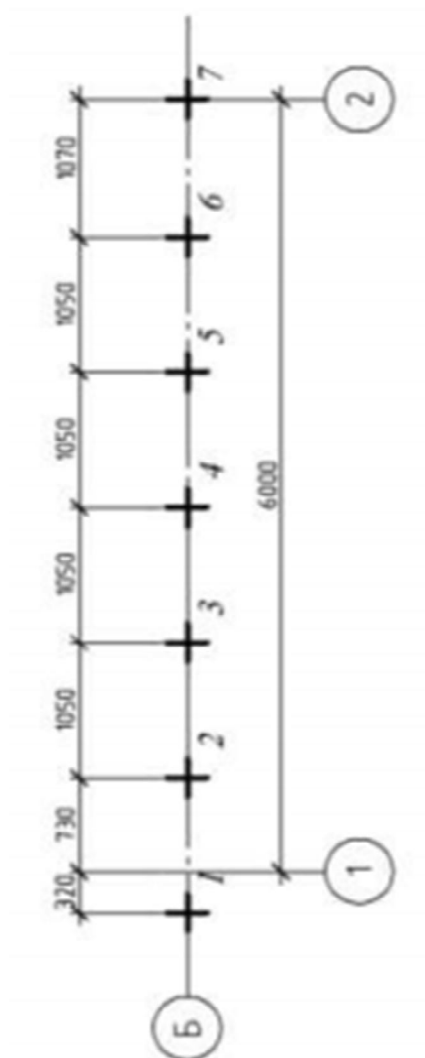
Пример оформления плана свай ленточного фундамента
